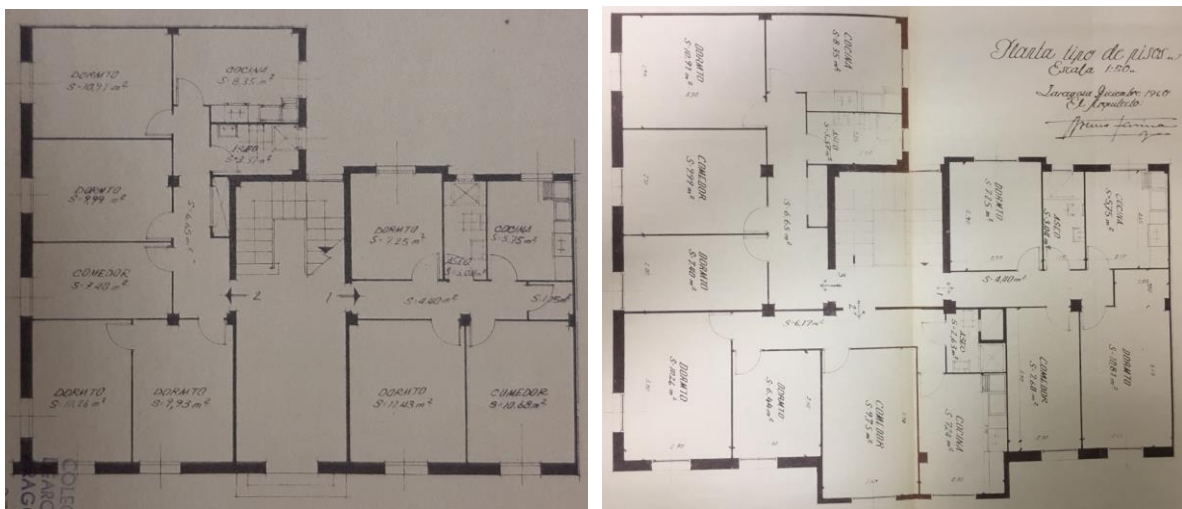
Planos de viviendas en plantas primera y segunda a quinta
